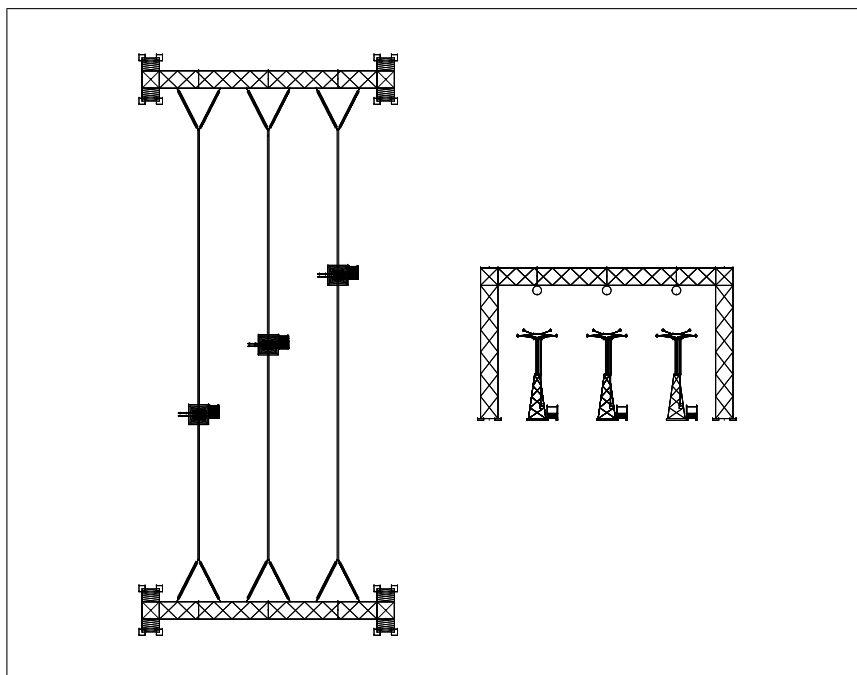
Conexión seccionador pantógrafo con barra flexible, vista en planta y en corte.
